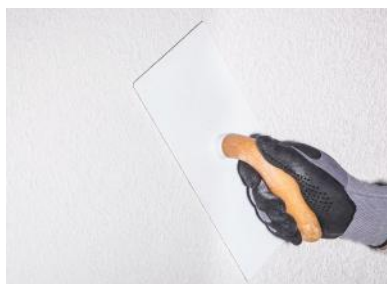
Vor dem Trocknen wird mit einer Kunststoffkelle darübergefahren, um die Oberfläche zu strukturieren.
